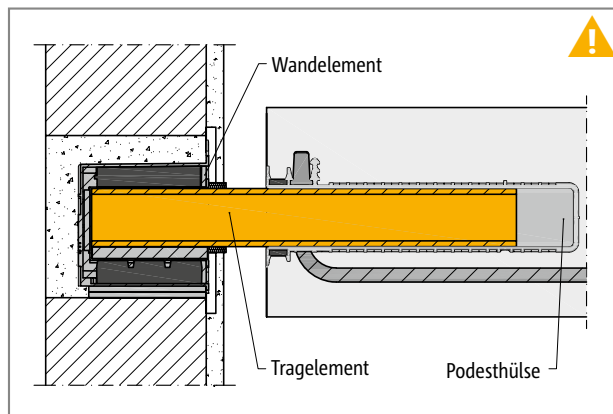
Schöck Tronsole® Typ P: Mehrteiliges Produkt (Wandelement, Tragelement, Podesthülse); Tragelement (gelb) muss auf der Baustelle eingebaut werden.
